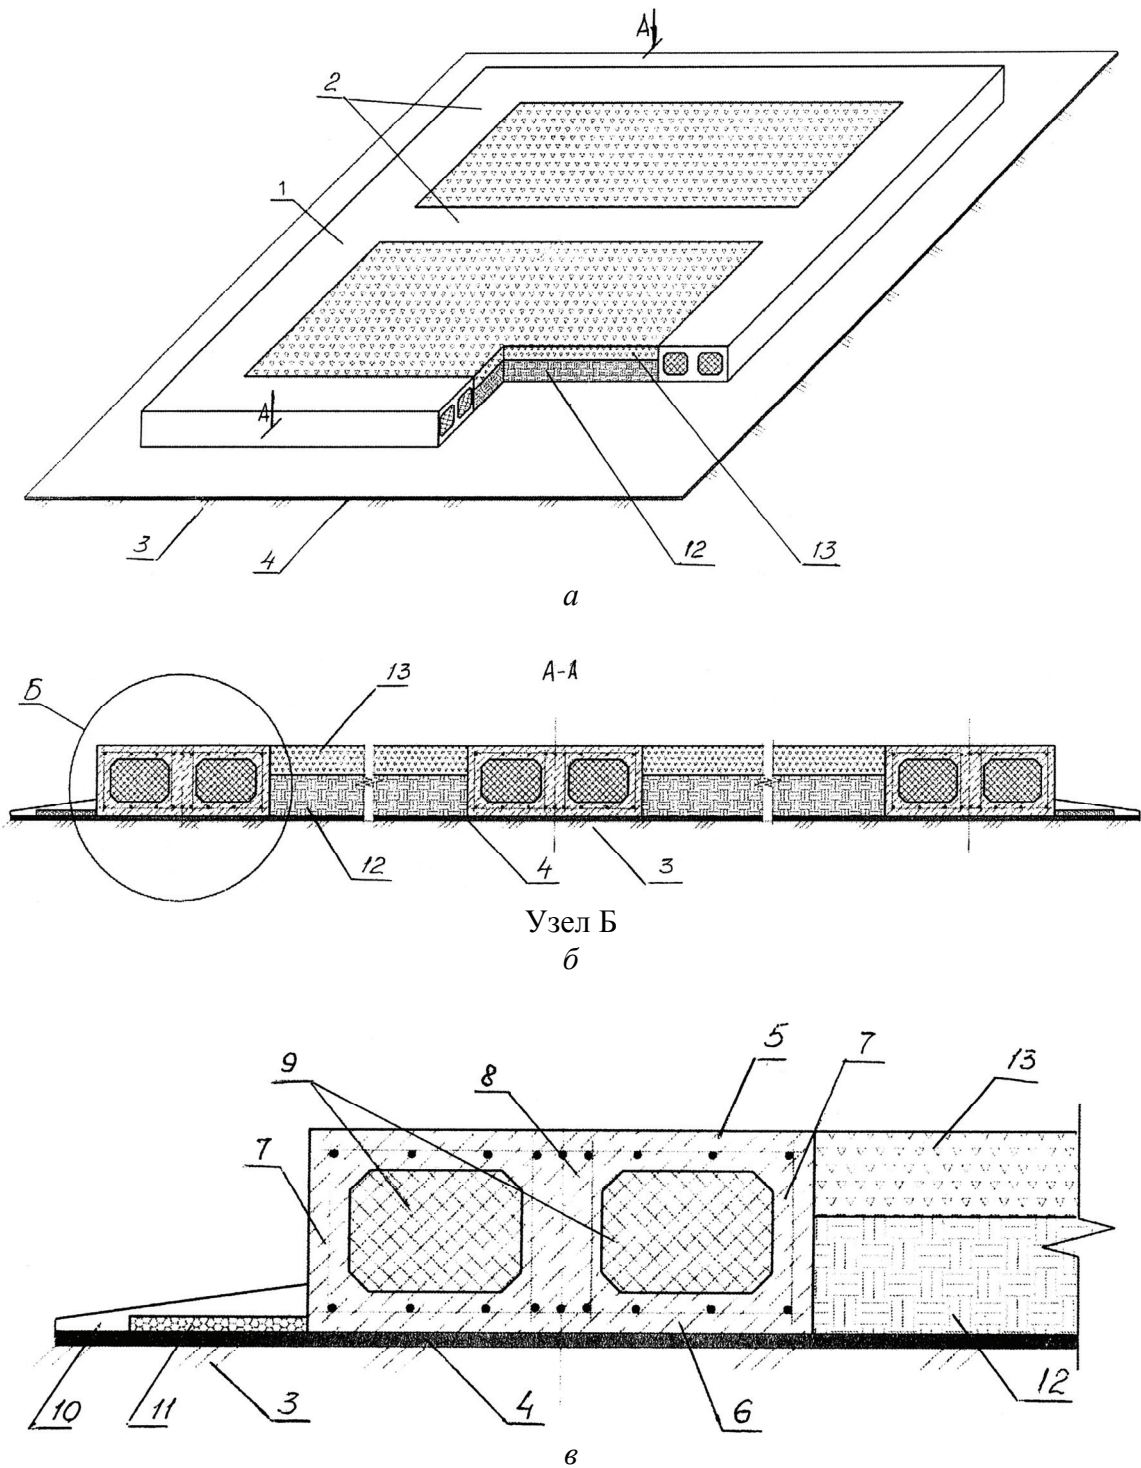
Плитно-рамный фундамент для малоэтажного строительства: а – общий вид фундамента; б – вид сбоку; в – узел Б: 1 – плитно-рамный фундамент; 2 – элементы фундамента; 3 – выровненное основание; 4 – гидроизоляционный слой; 5 – верхняя железобетонная плита, 6 – нижняя железобетонная плита; 7 – крайние боковые ребра; 8 – утолщенное среднее ребро; 9 – плитный утеплитель; 10 – отмостка; 11 – утеплитель для пучинистых грунтов; 12 – земляная масса; 13 – утеплитель
